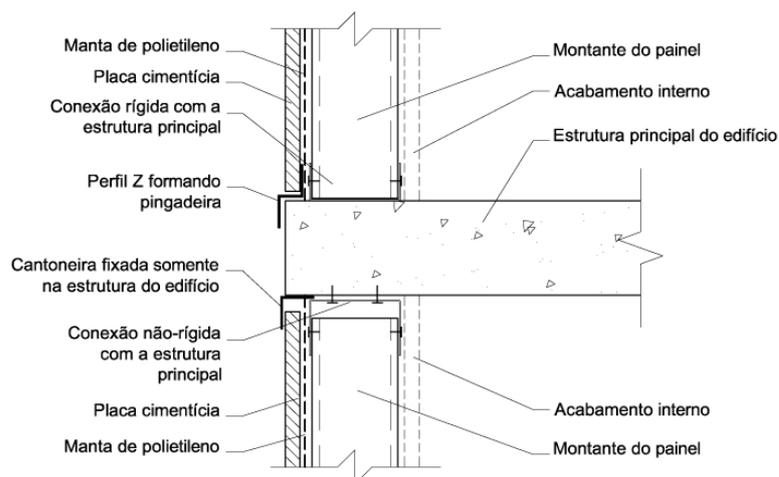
Painel embutido não-rígido com placa cimentícia e estrutura principal aparente
